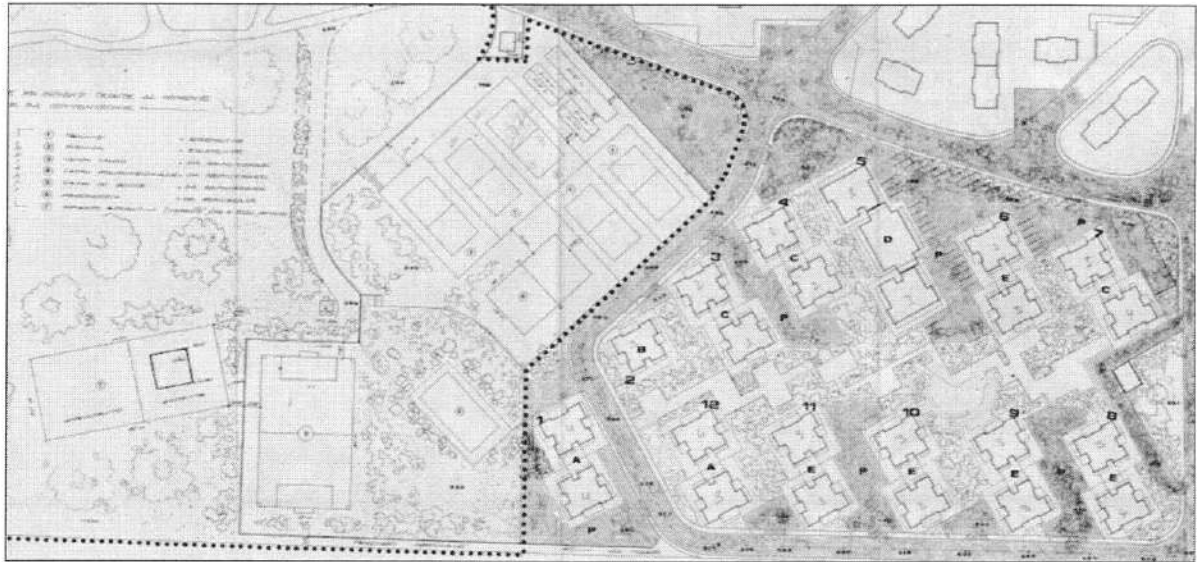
Stralcio planimetria con indicazione dei fabbricati e relativi lotti fondiari.
